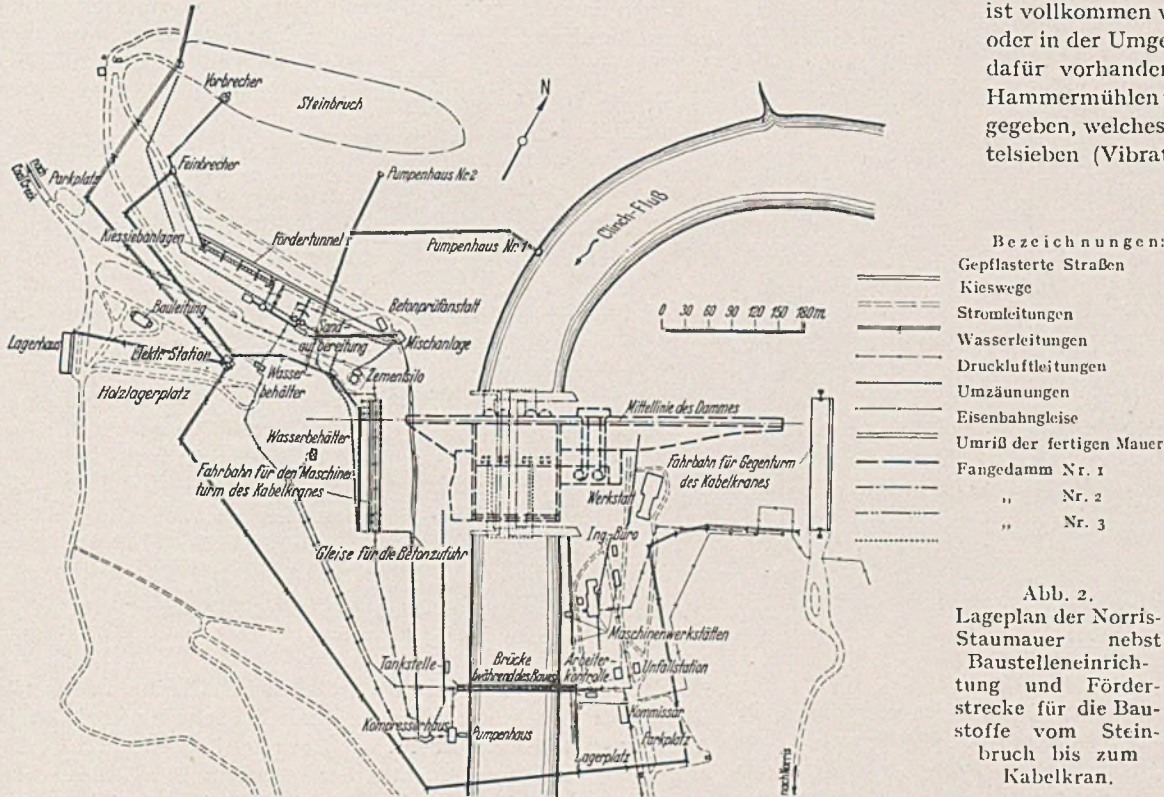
Lageplan der Norris-Staumauer nebst Baustelleneinrichtung und Förderstrecke für die Baustoffe vom Steinbruch bis zum Kabelkran.
